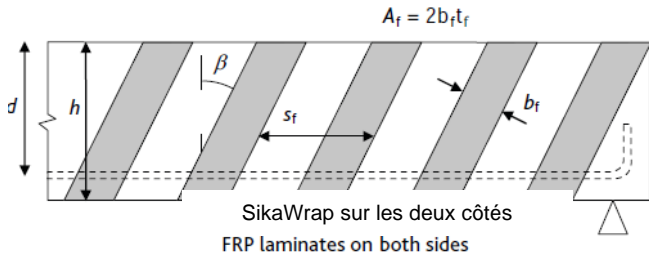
Principe de renforcement à l'effort tranchant – Poutre rectangulaire
